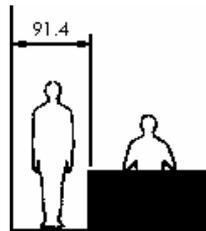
Circulação entre parede e móvel baixo para uma pessoa.
